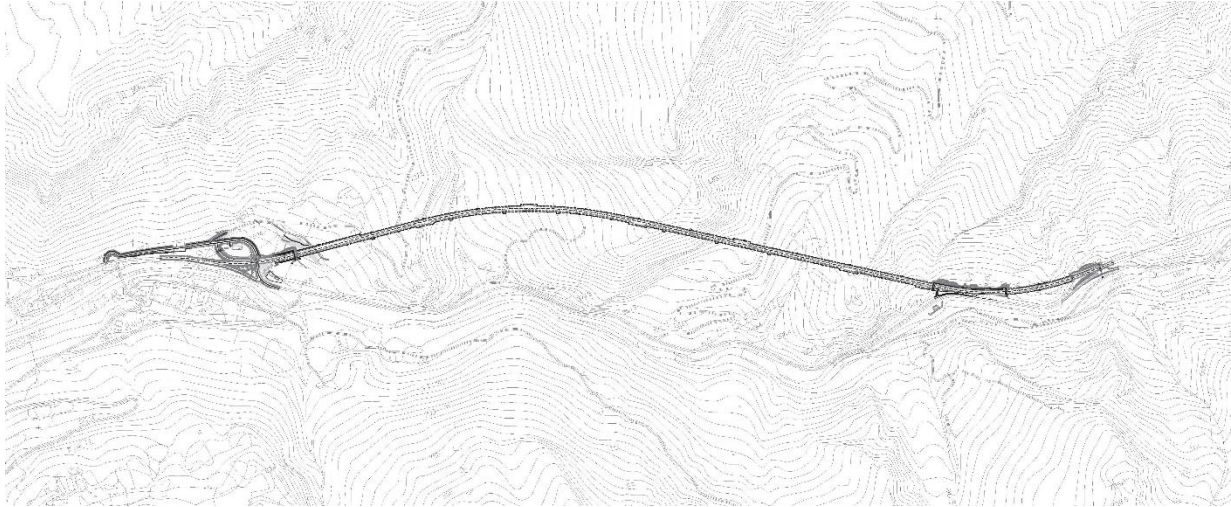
AN 256 – SS4 Salaria – Tratto Trisungo – Acquasanta Terme 1°Lotto 2° Stralcio dal km 151+000 al km 153+780 - Planimetria
